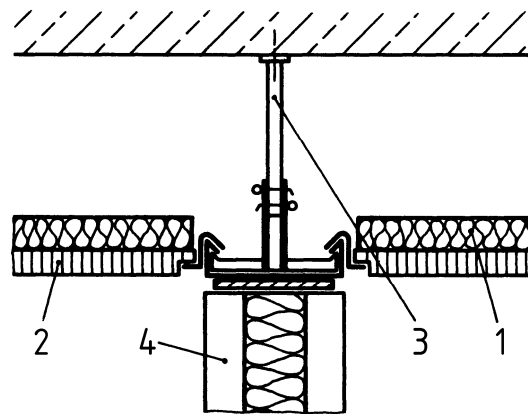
Trennwandanschluss an Massivdecke mit Trennung der Unterdecke in Decklage und Unterkonstruktion
